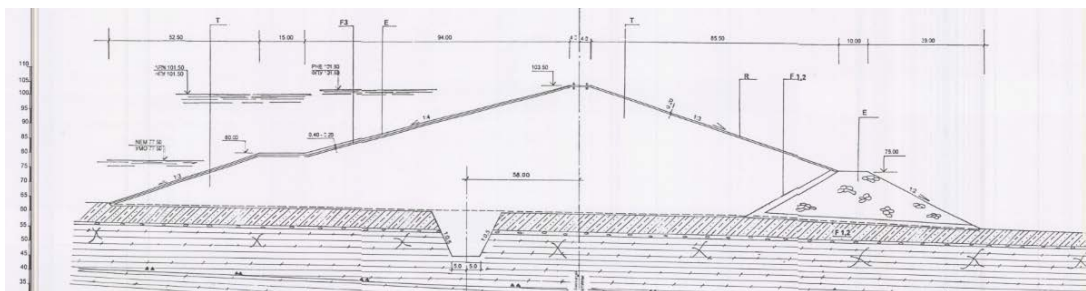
Perfil tipo da barragem Saída (projeto original)
